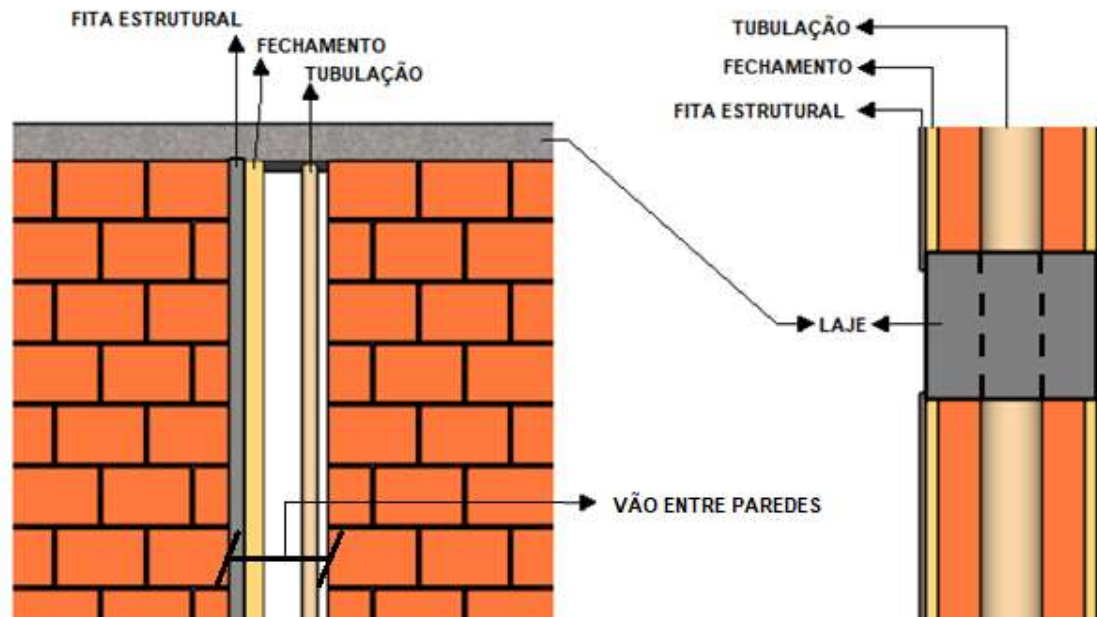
Detalhamento de parede hidráulica. Fonte: Própria.
